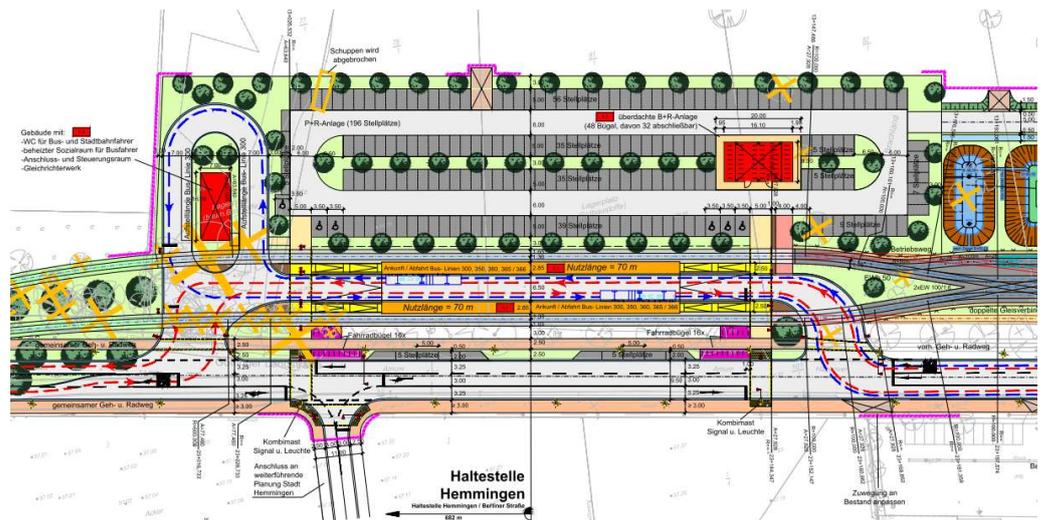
Endhaltestelle Hemmingen (Quelle: Transtec, Lageplan 05/2014)
